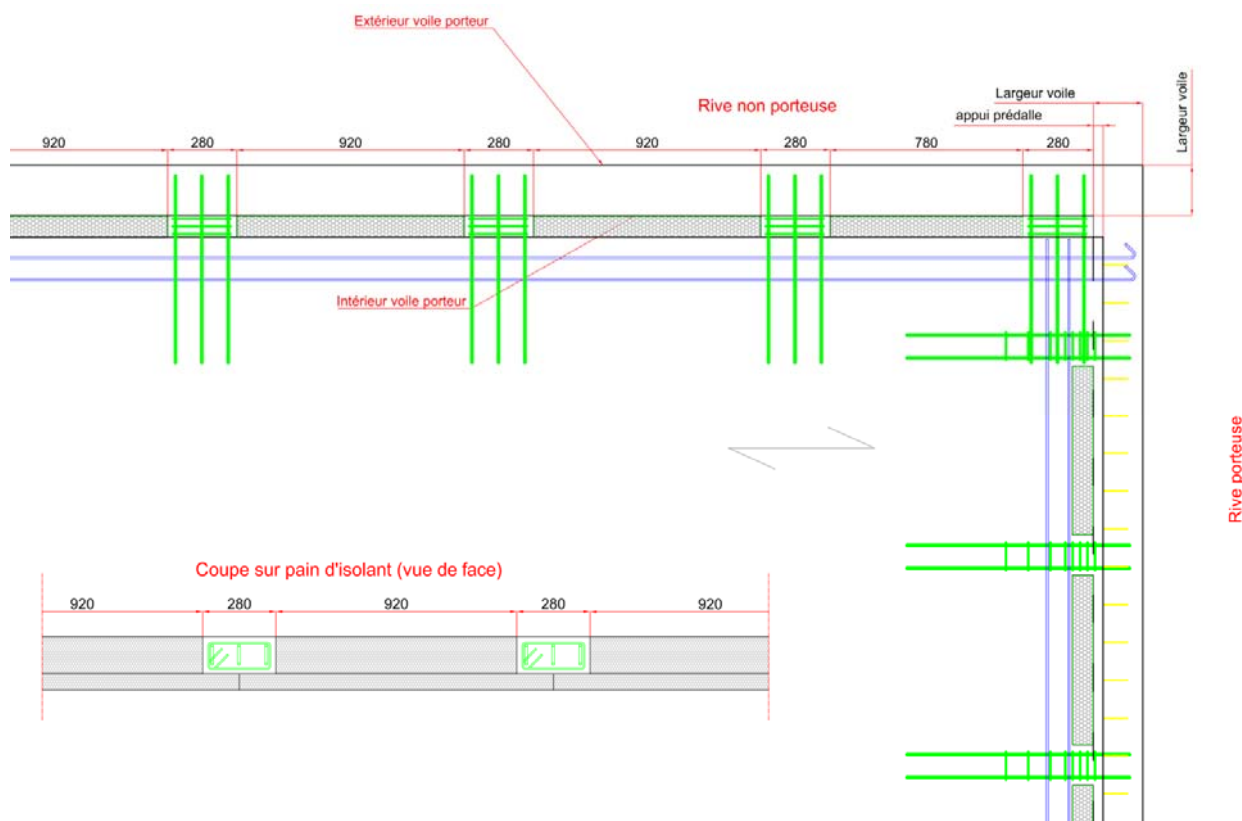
Cas de la prédalle d'angle et d'about - Vue en plan – Coffrage -
